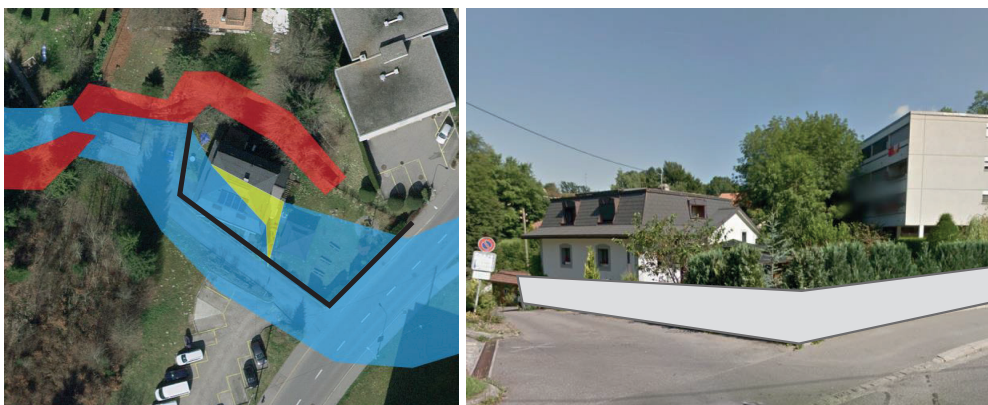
Schéma Concept mesure individuelle - secteur Vauguény
